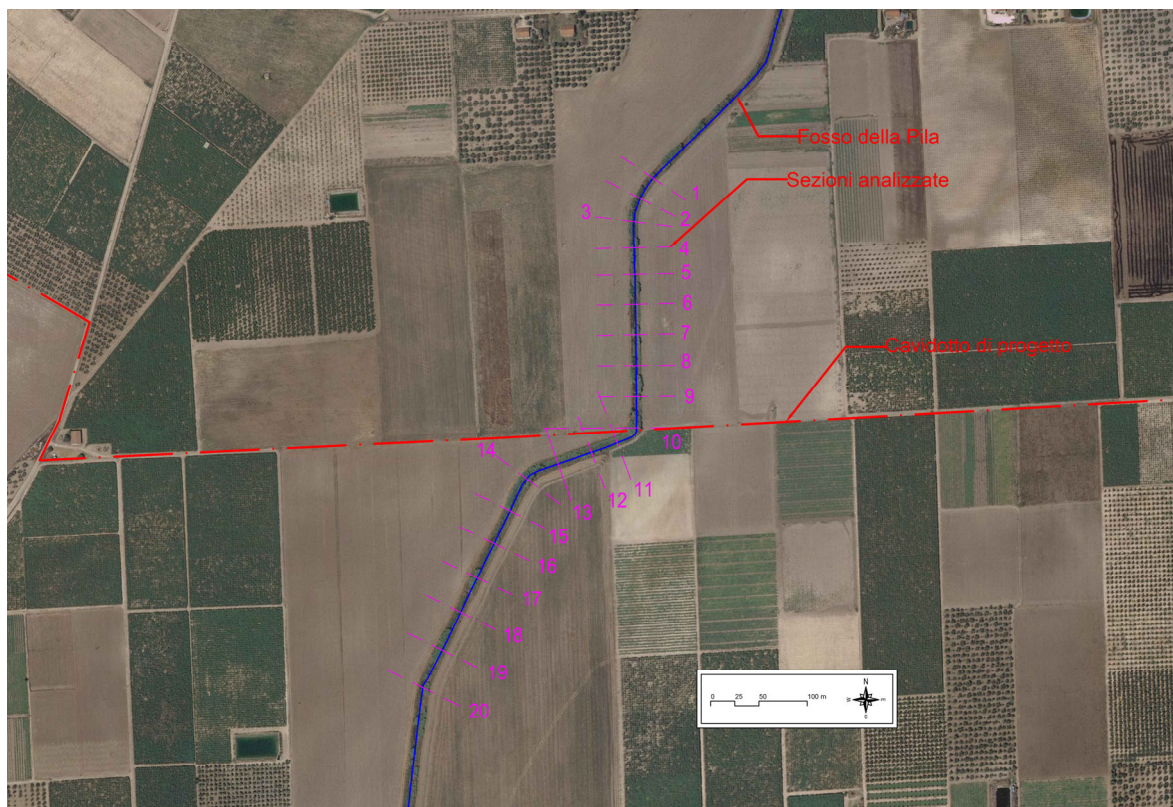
Planimetria Fosso della Pila, tratto analizzato
